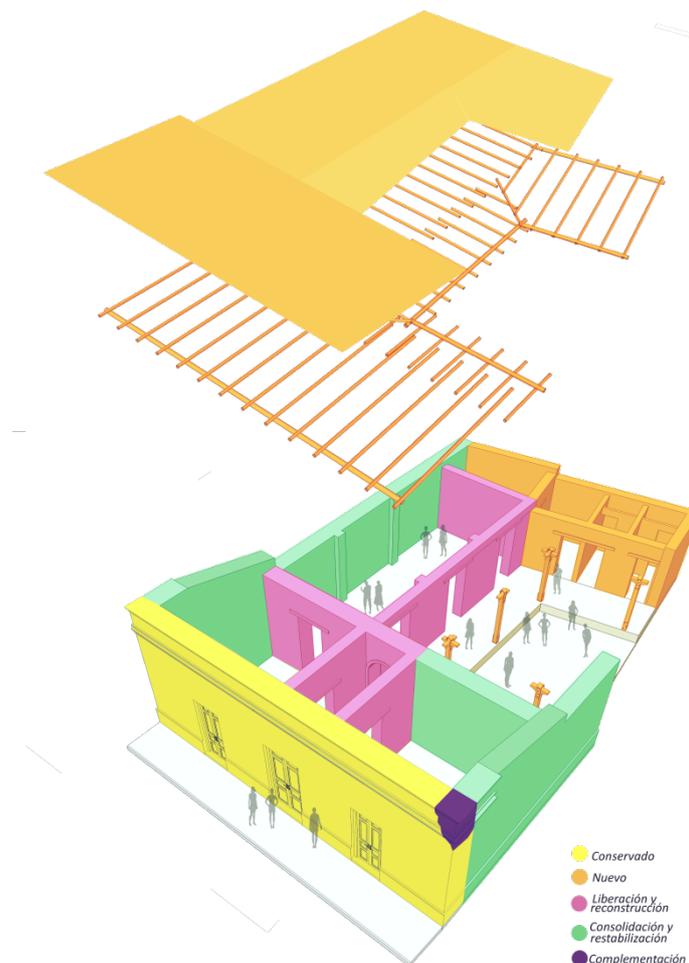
Volumetría de la vivienda intervenida indicando las acciones realizadas
